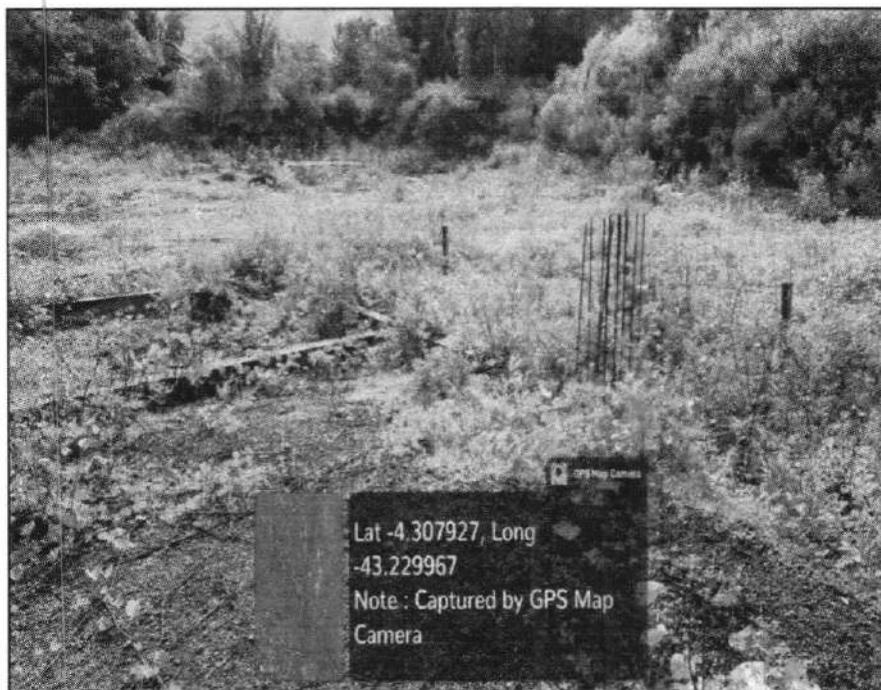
Vigas baldrames encontram-se expostas e sem o aterro previsto executado. Fonte: elaboração própria
